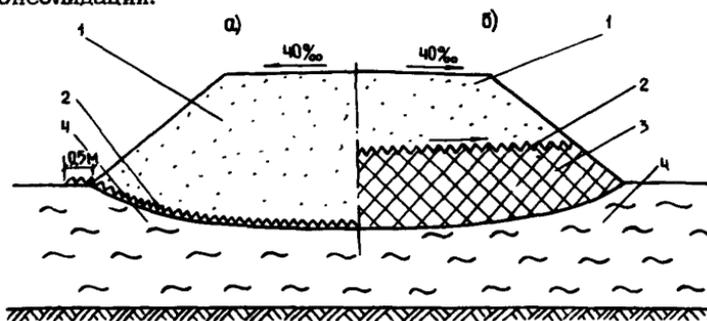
Конструкция насыпи на слабом грунте с прослойкой из НСМ в основании насыпи (а) или над нижней частью насыпи из местного грунта (б): 1-песчаная насыпь; 2-прослойка из НСМ; 3-местный насыпной грунт; 4-слабый грунт
